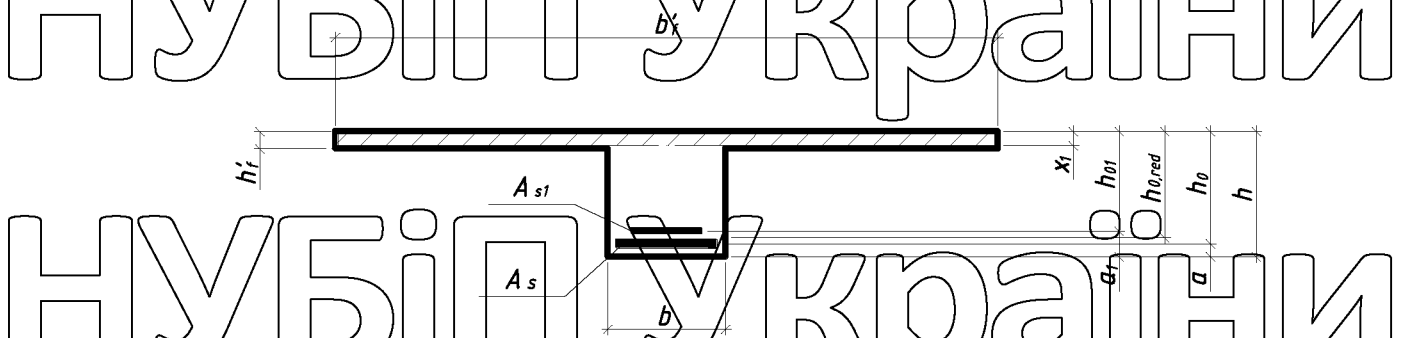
Розрахунковий переріз плити з підсиленням.
